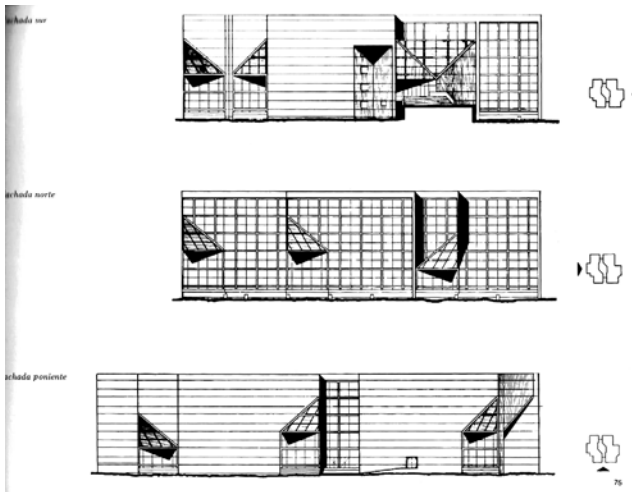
Fachada sur, norte y poniente de hemeroteca.
